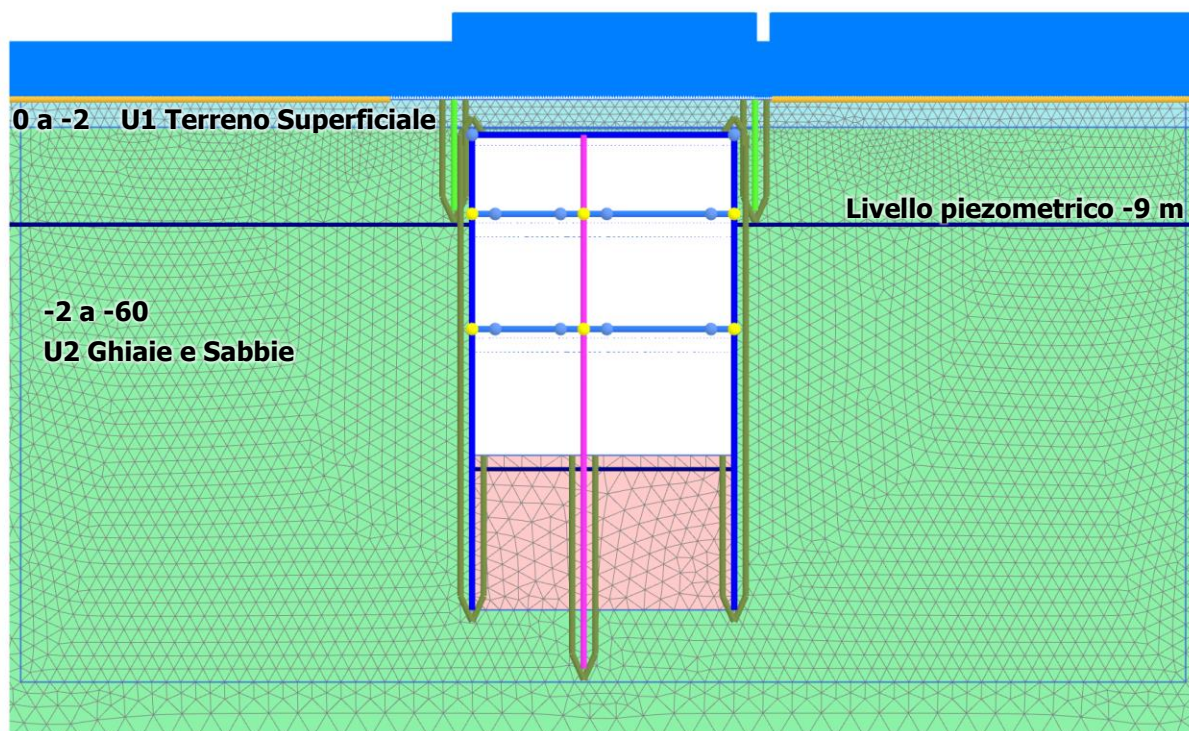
Sezione di calcolo 2- Stazione Cimarosa
